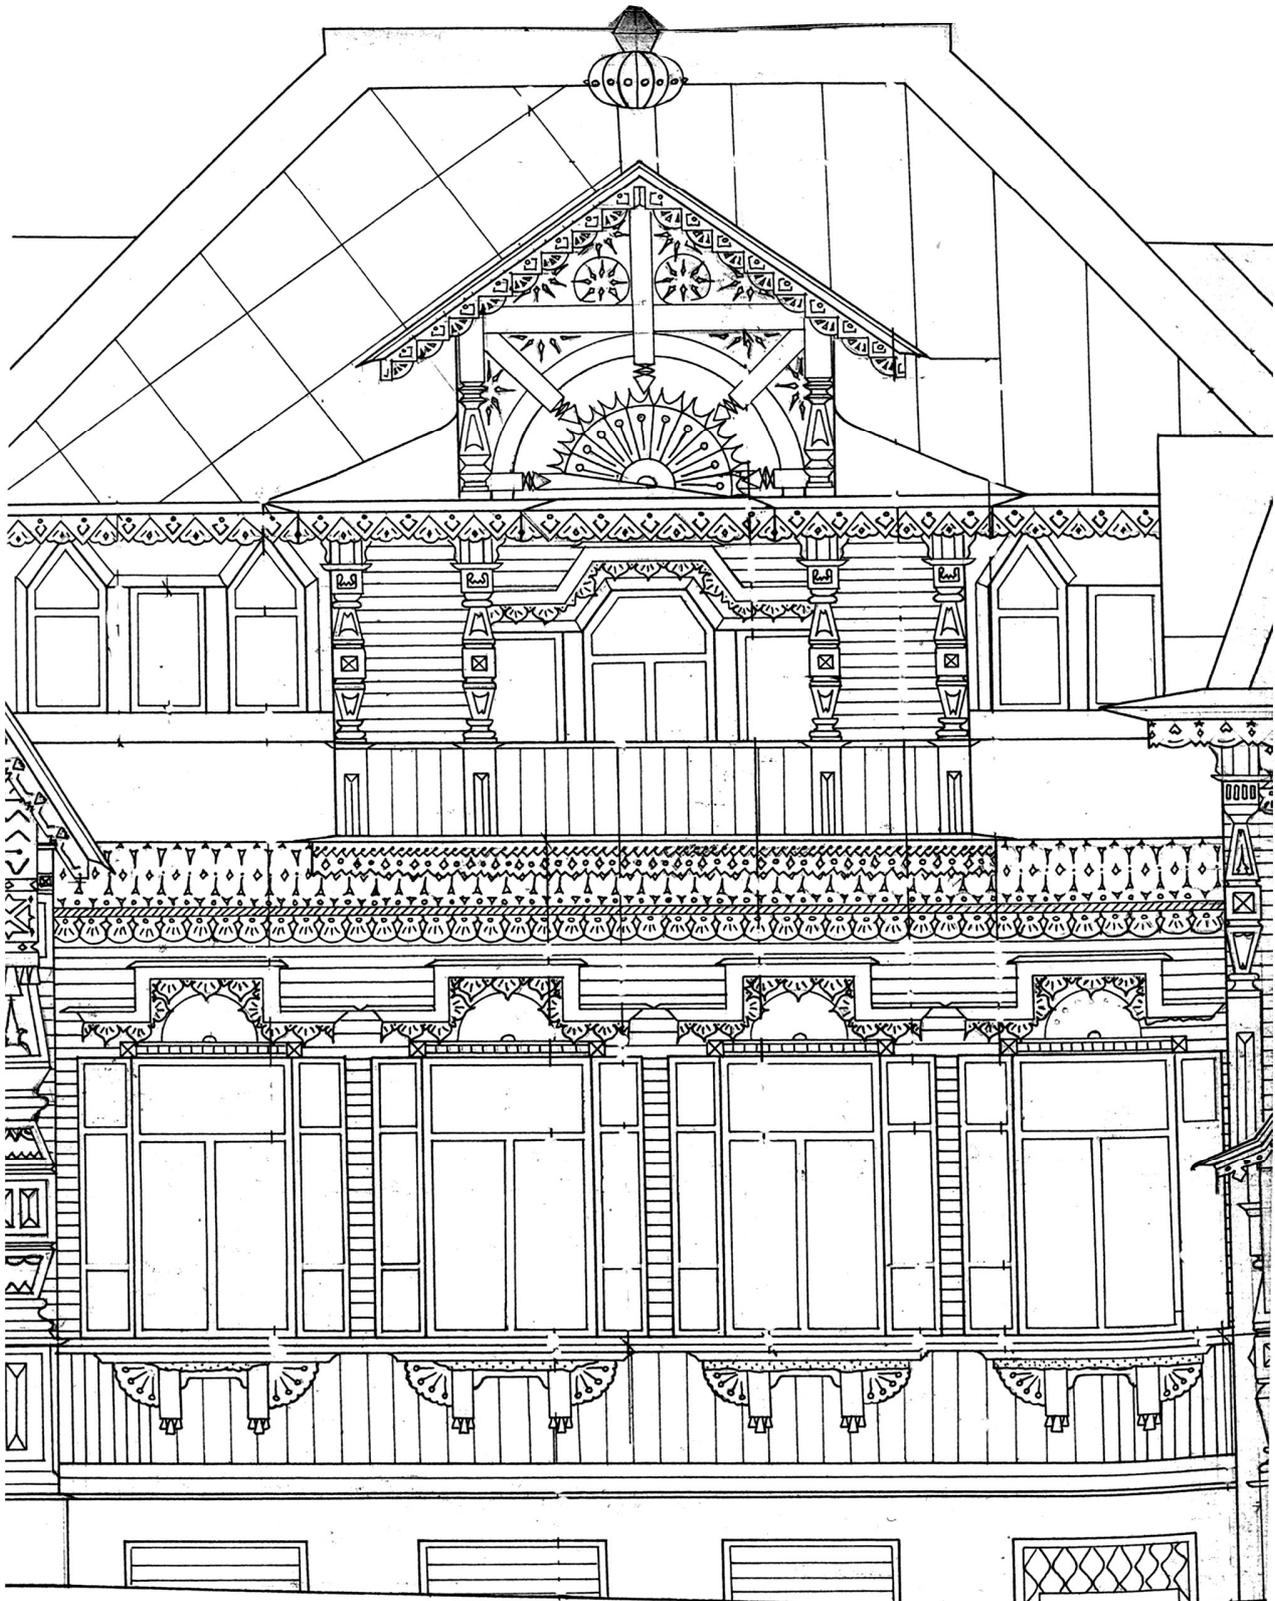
Фрагмент фасада жилого дома на ул. Дальней, 15. Обмерный чертеж
